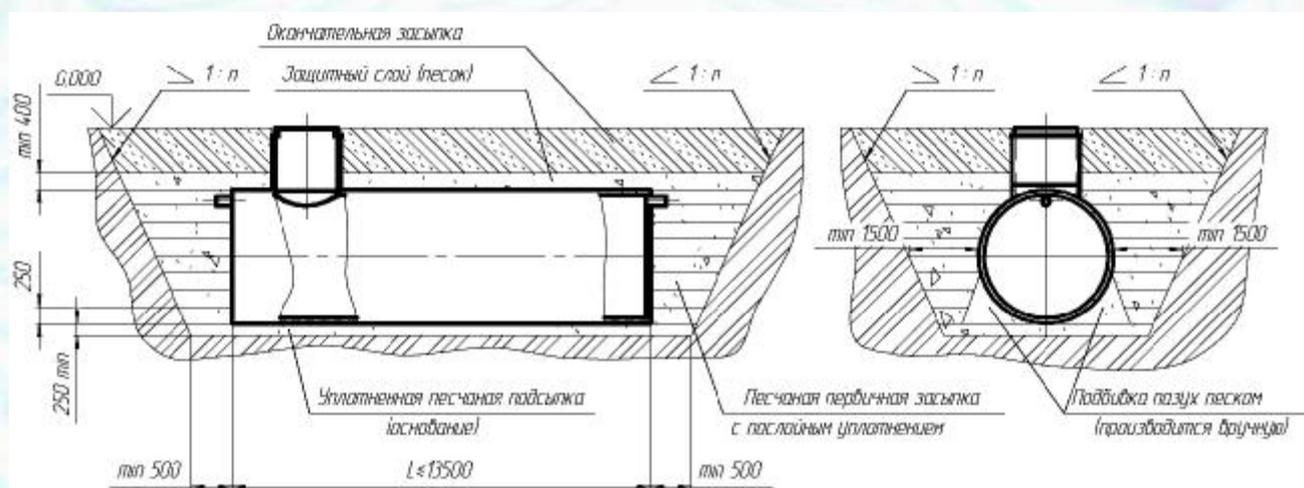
Схема подземного монтажа резервуара длиной до 13500 мм в сухих грунтах без воздействия транспортной нагрузки
